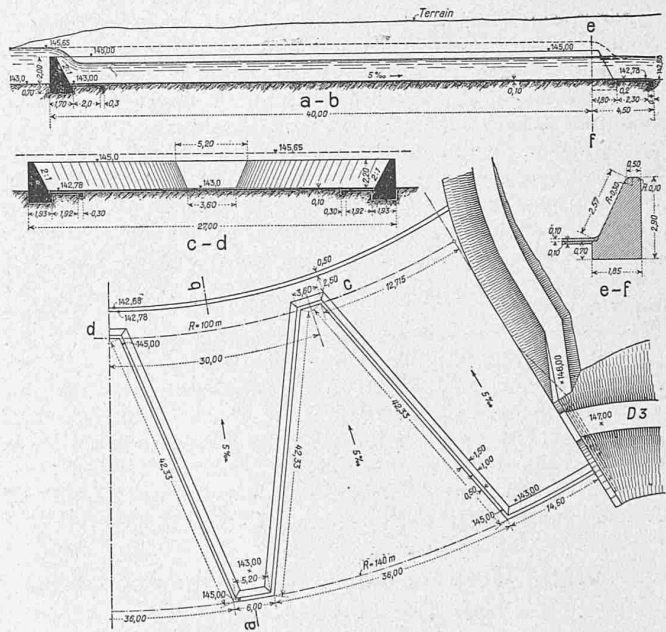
Ueberlauf-Grundriss 1:1000, Schnitte a-b und c-d 1:500, e-f 1:250.
